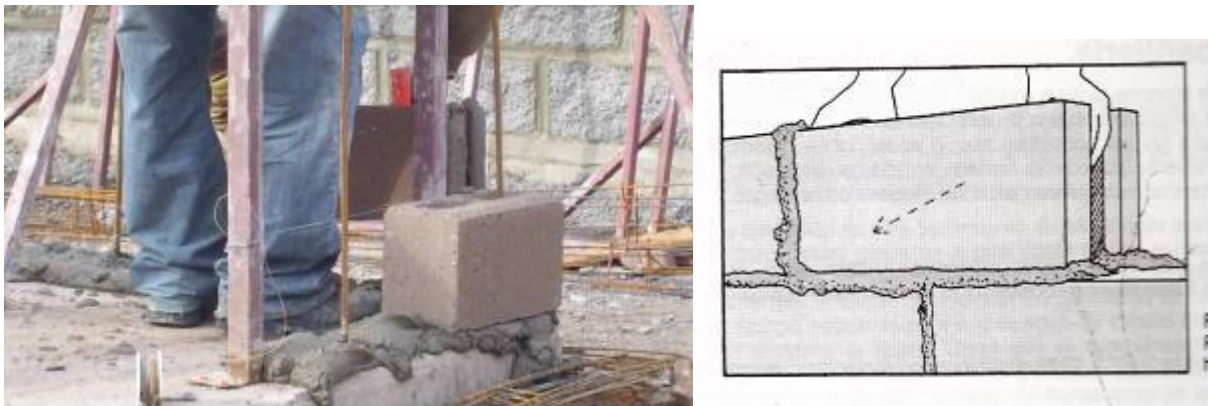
Colocación y posicionamiento de un bloque en sitio.
